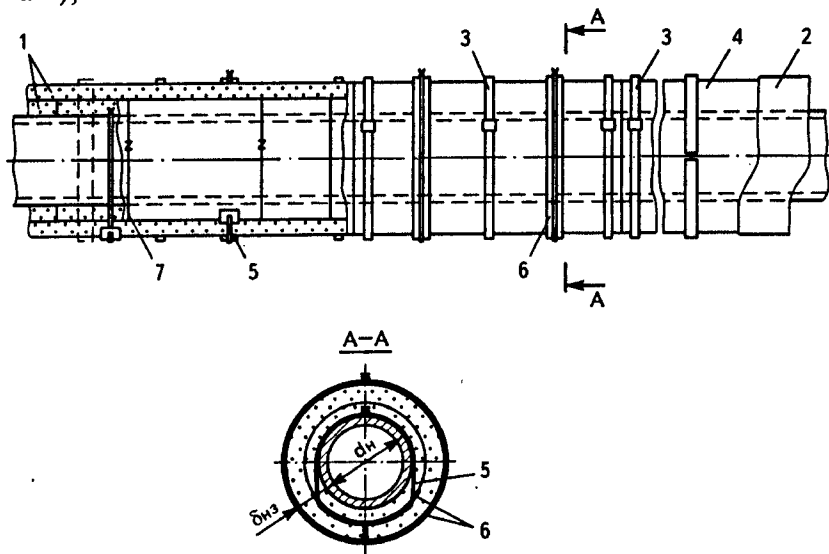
Изоляция трубопроводов теплоизоляционными матами в два слоя с креплением бандажми и подвесками:
